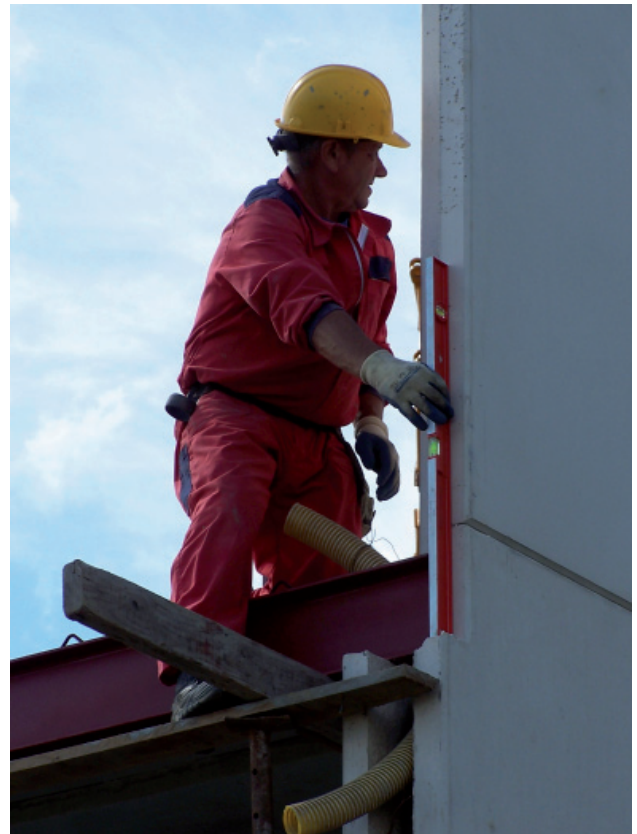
Aplomado previo al apuntalamiento. Detalle del desagüe de pluviales de la terraza aprovechando el hueco en el muro.
